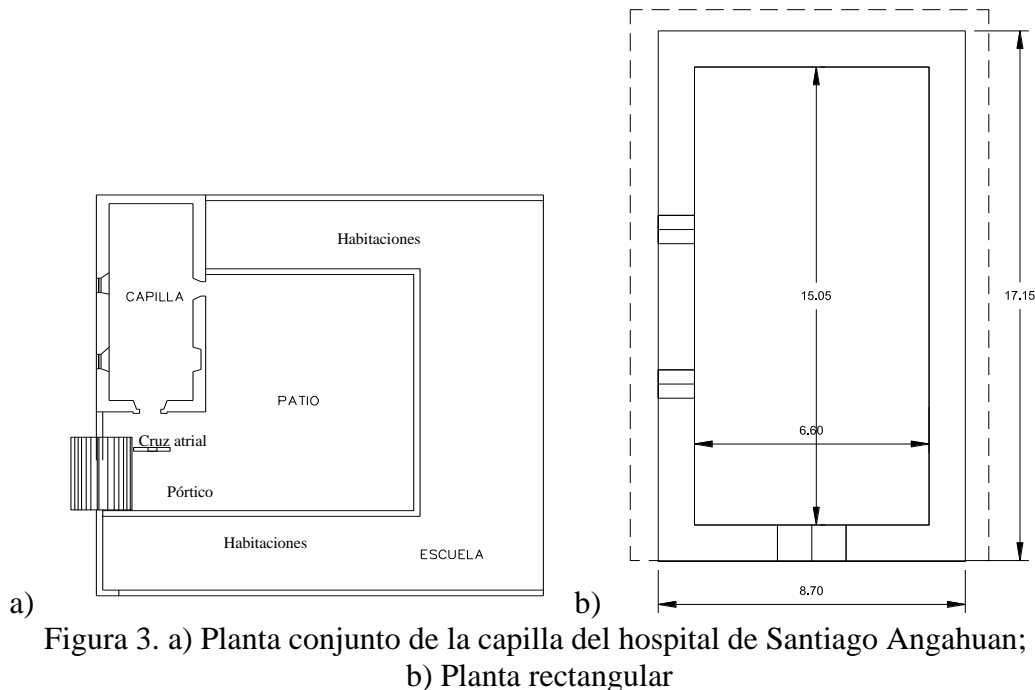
a) Planta conjunto de la capilla del hospital de Santiago Angahuan; b) Planta rectangular
